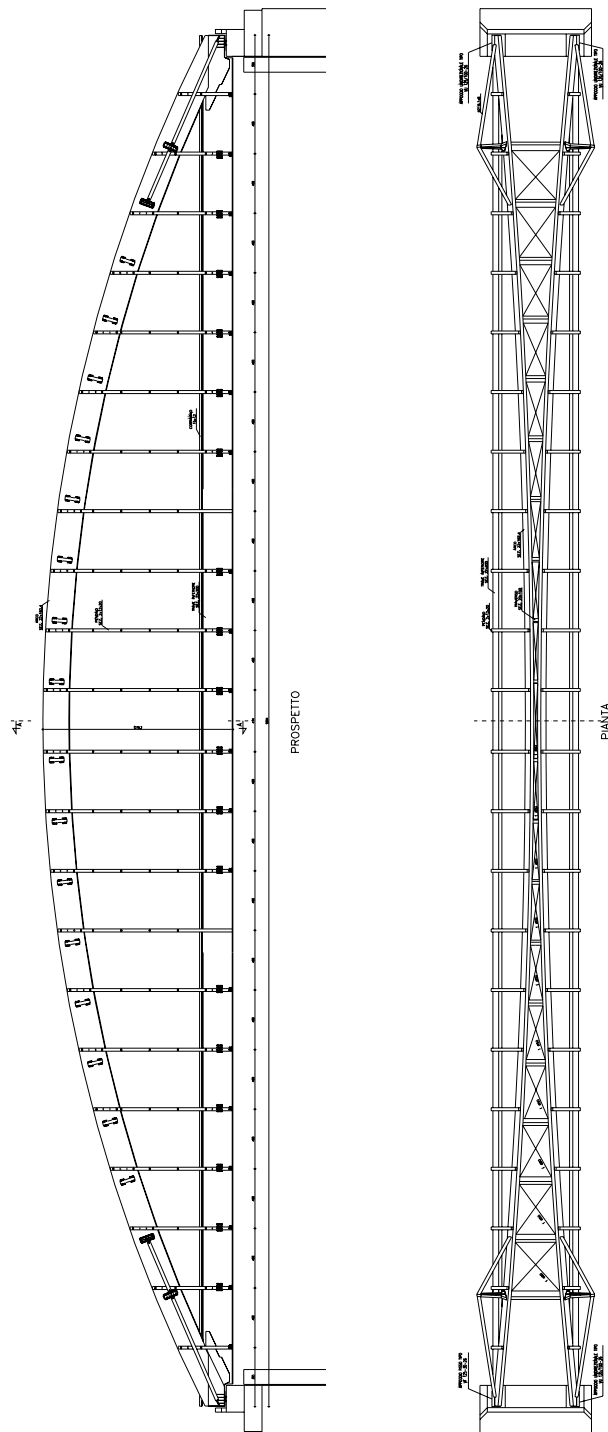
Prospetto e pianta del ponte ad arco con indicazione della posizione degli accelerometri e della vibrodina.
